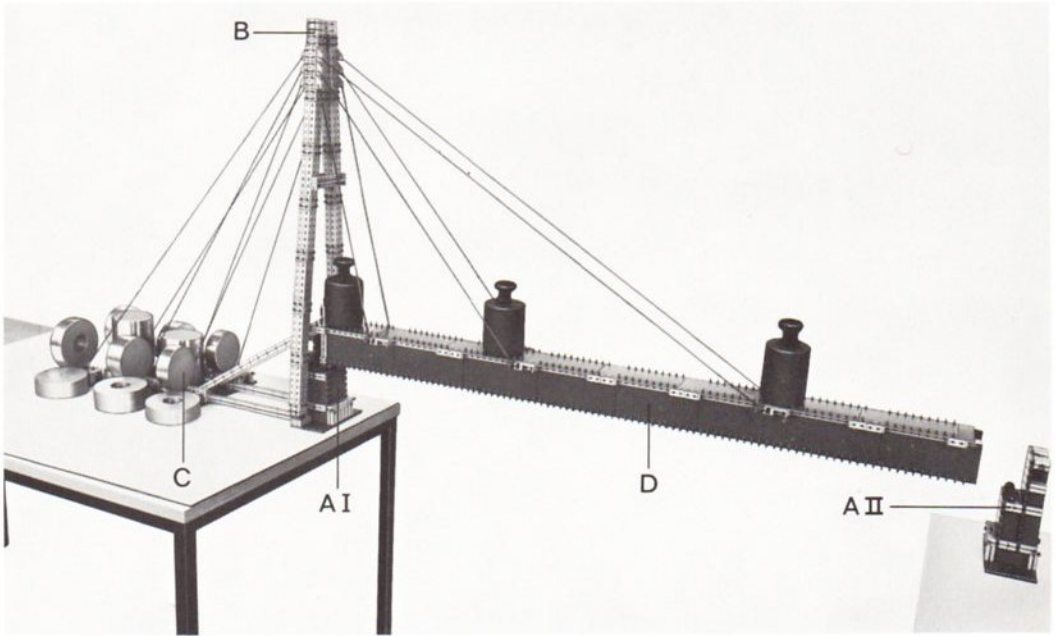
Modell einer Schrägseilbrücke aus Bauteilen von 10 Lernbaukästen u-t1 und Bauelementen von 8 Lernbaukästen u-t S
